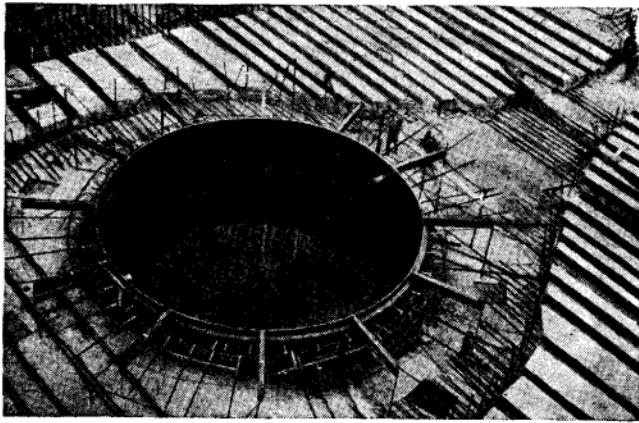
Устройство перекрытий водосбросов ГЭС из сборных железобетонных элементов
